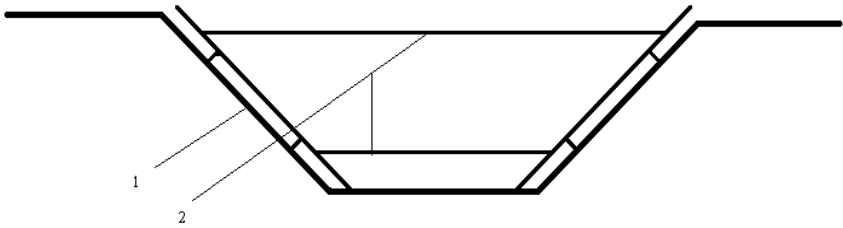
Схема размещения опалубки в канаве для устройства слоя шламогрунта:
